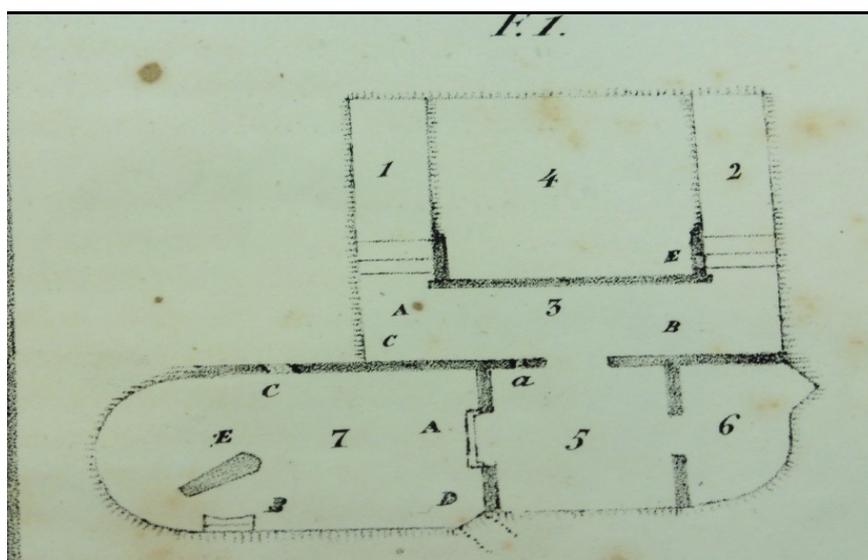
plan « inversé » de la construction. Dessin et plan de F. Gudin
